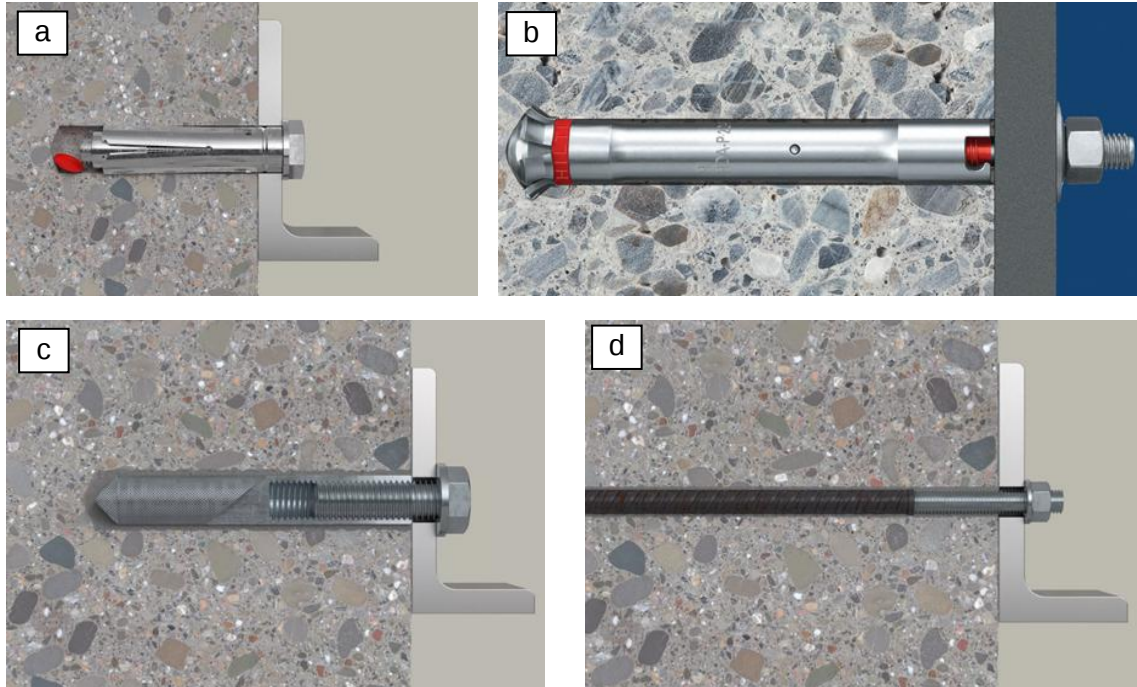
Ausgewählte, befestigungstechnische Lösungen (a) Schwerlastanker, b) Hinterschnittanker, c): eingemörtelter Anker mit Innengewinde, d) eingemörtelter Bewehrungsanker mit aufgeschweißtem Gewinde); Bild a), c), d) [Stah], Bild b) [Deut]
